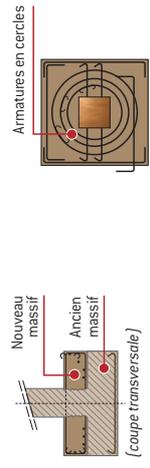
Fondations : sans augmentation de la surface de semelle (vue en plan)
